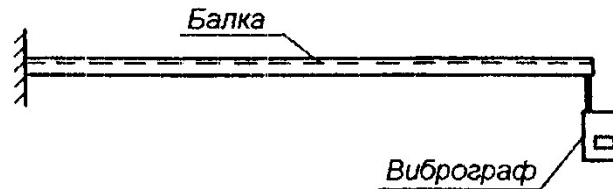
Общий вид балки для испытания динамической нагрузкой
